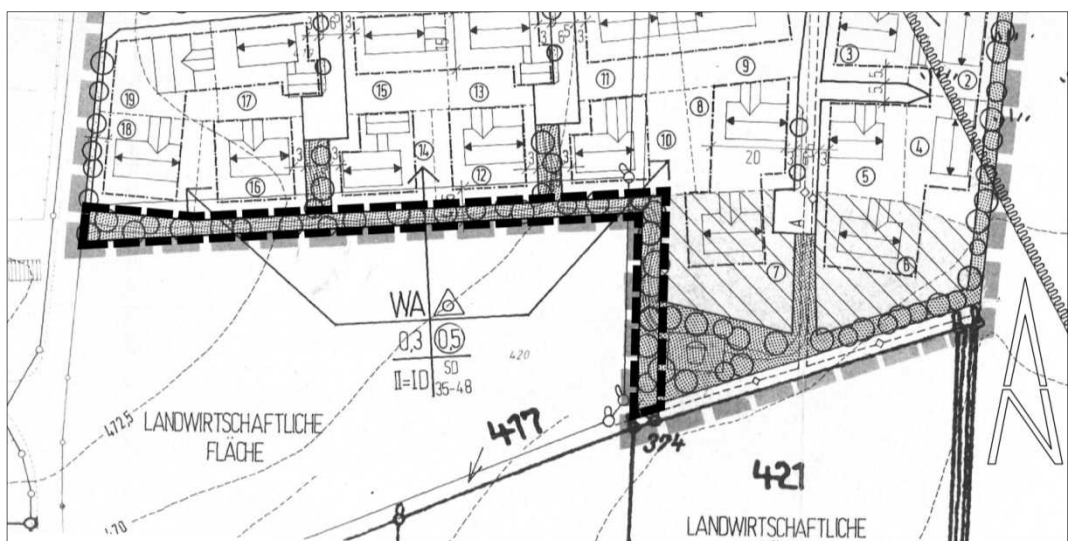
Bebauungsplan „Birkele“ - Aufhebungsbereich
